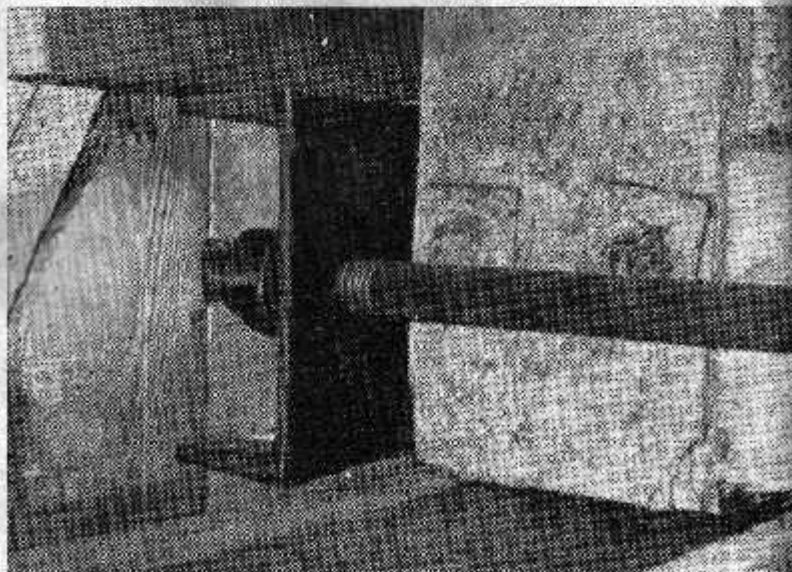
Крепление тяжа на опоре гвоздевой балки
